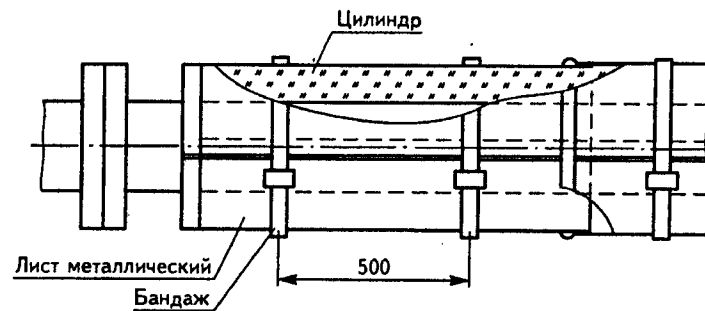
Изоляция цилиндрами. Крепление покрытия бандажами
